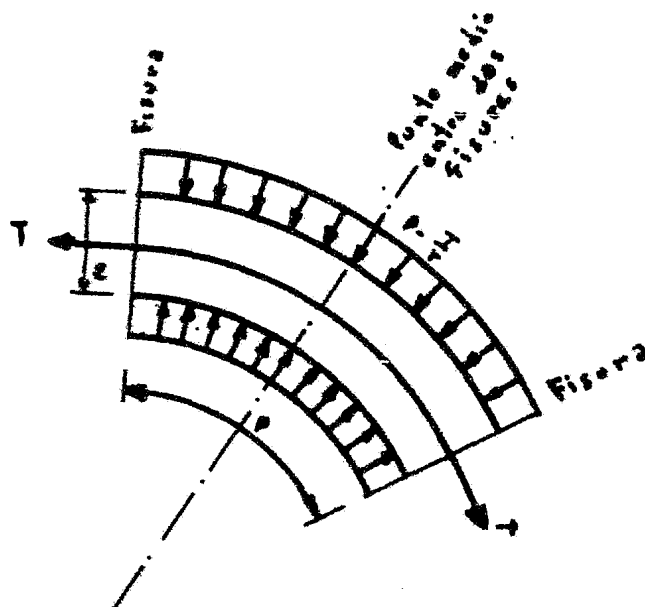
Esquema de cálculo del revestimiento de una galería de presión. El concreto está fisurado
